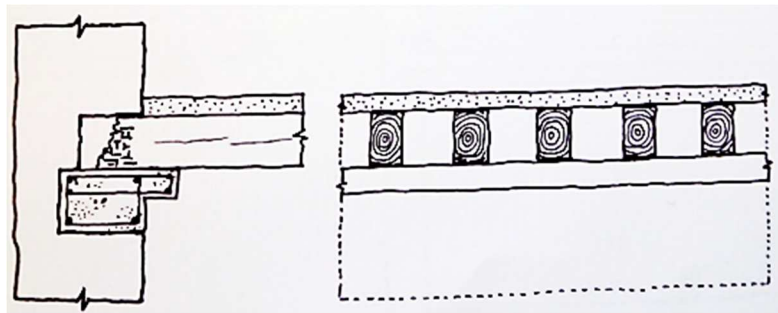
Apeo sobre viga carrera realizada con perfil metálico.
